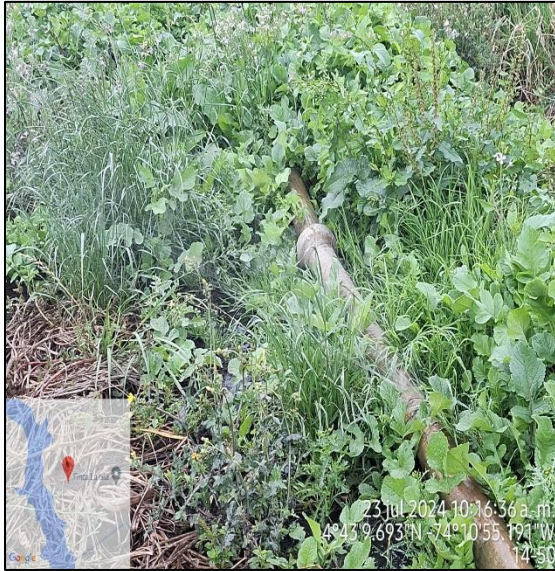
y 7. Tubería de alimentación y sistema de riego.
